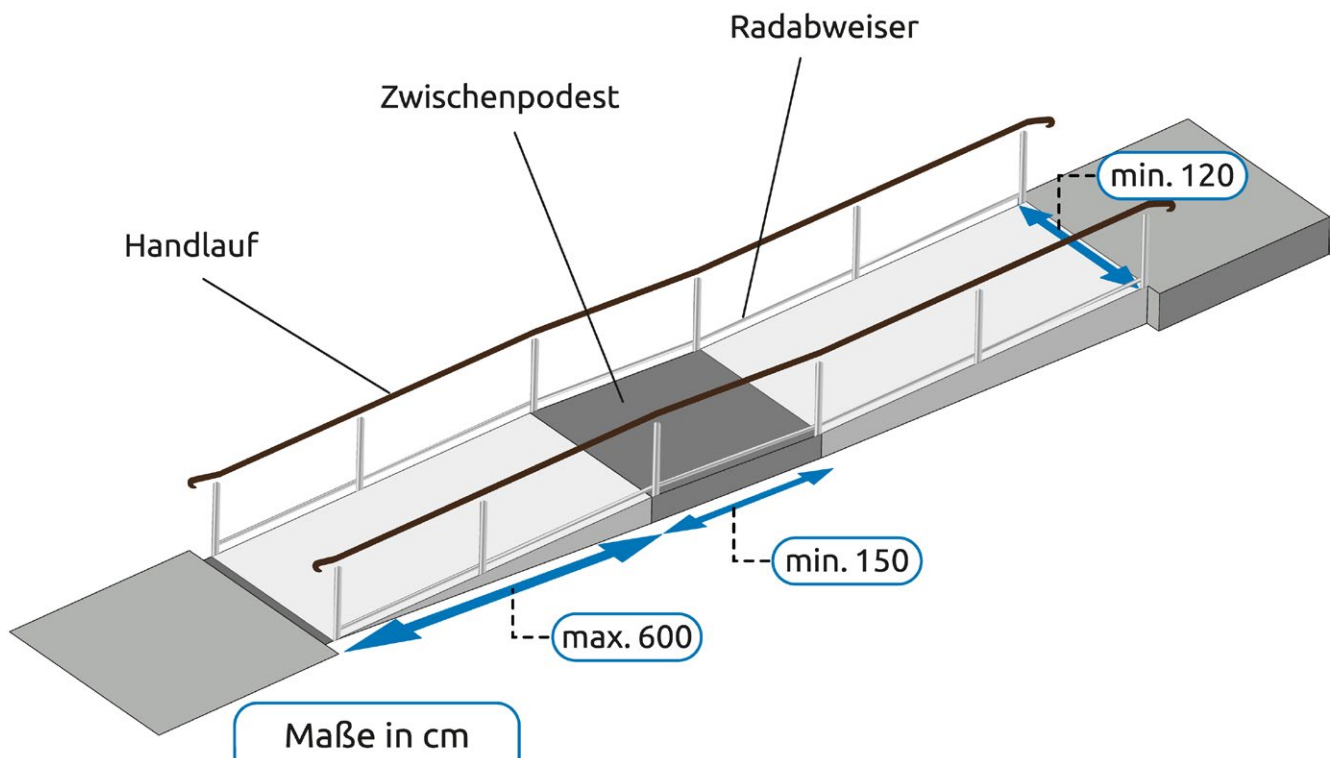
Rampe mit beidseitigen Handläufen und Radabweisern
